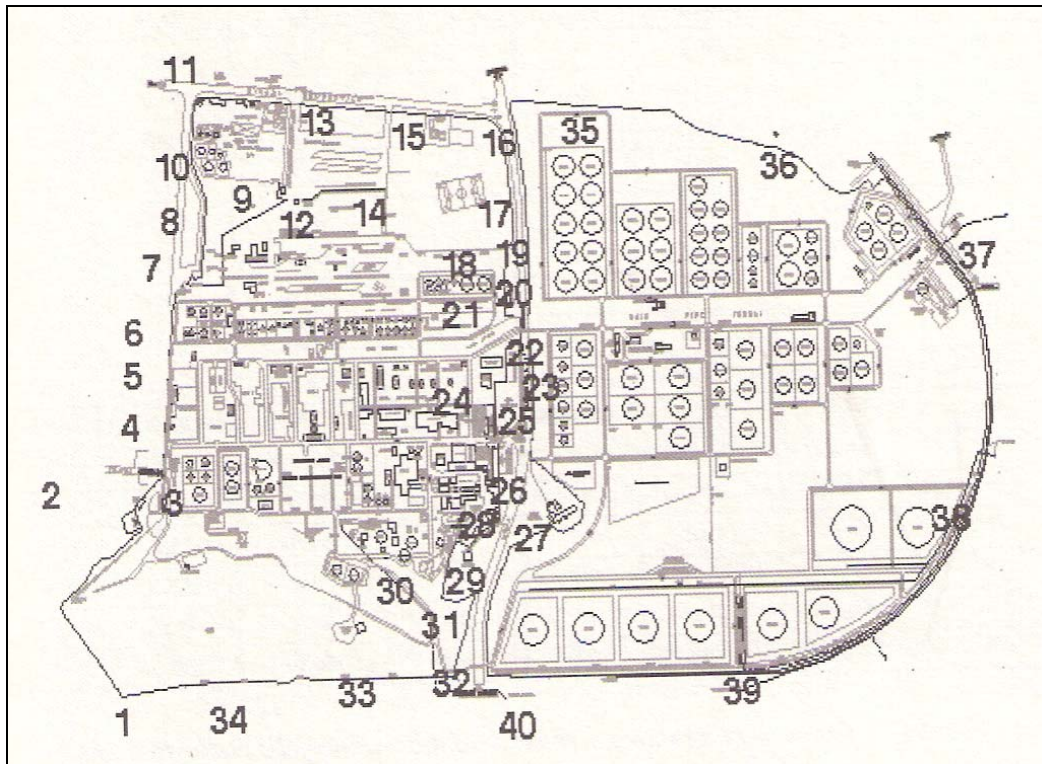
Planimetria della Raffineria con punti di monitoraggio
